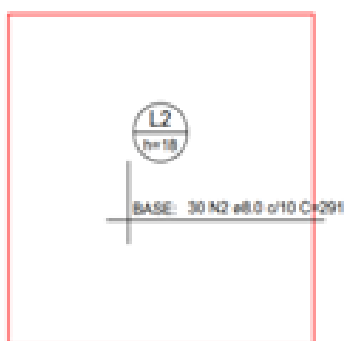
Armação inferior do radier do pavimento posso do elevador no eixo X
